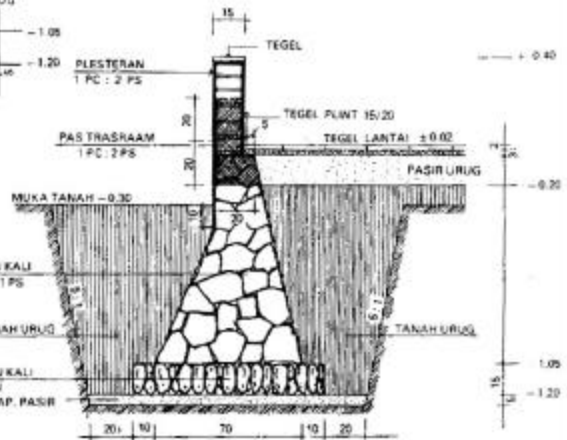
Denah Rencana Pondasi Pasangan Batukali
